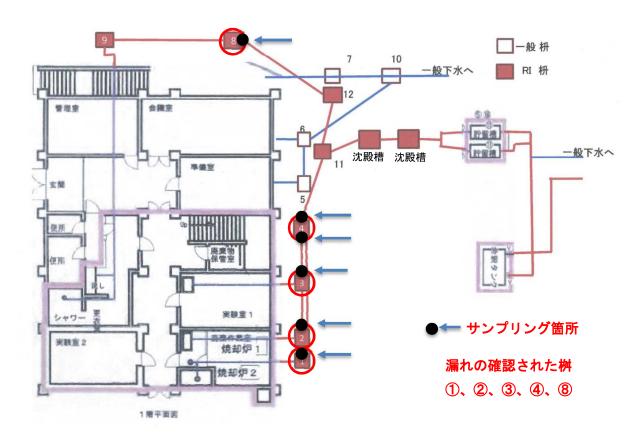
施設平面図及び亀裂が発見された桝の位置
